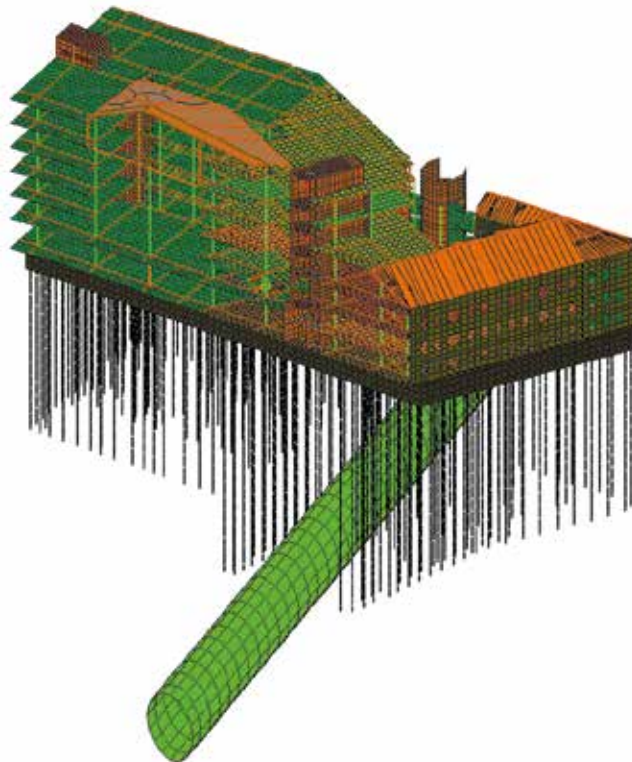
Фрагмент расчетной схемы. Конструкции здания, наклонный ход
